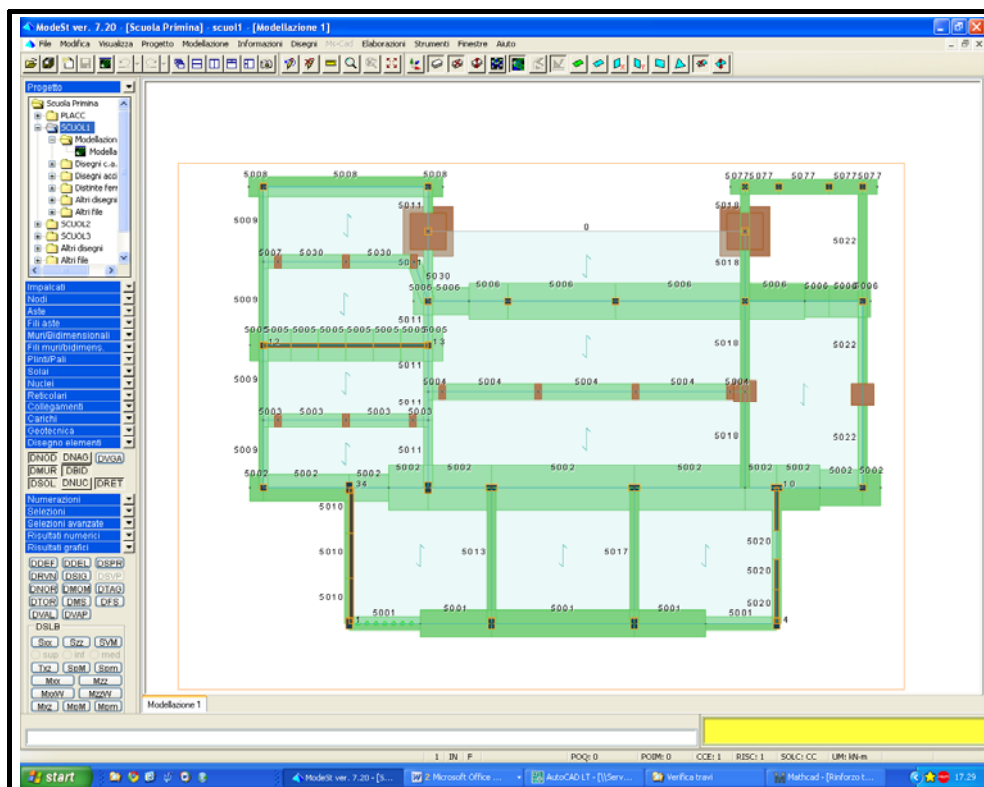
Pianta delle fondazioni (quota +0.00)
